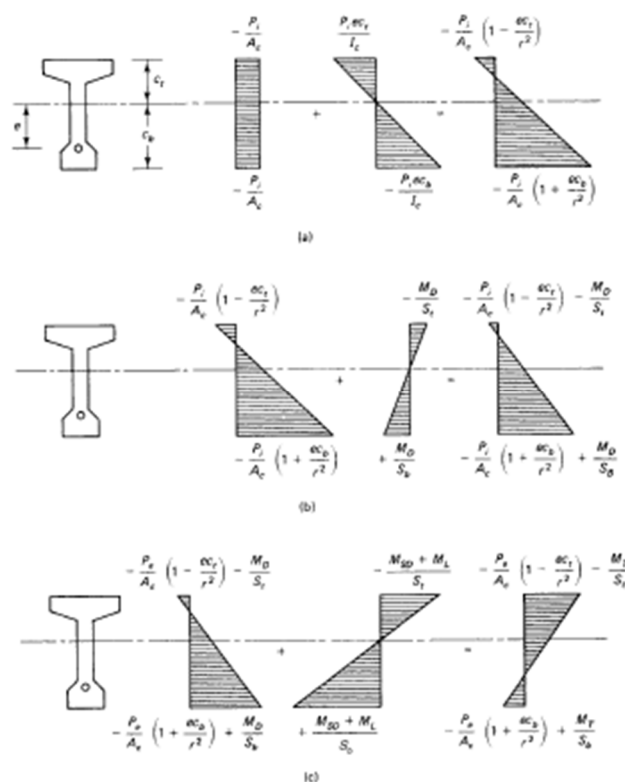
Esfuerzos de fibra elástica debido a las diversas cargas en una viga pretensada. (a) Pretensada inicial antes de las pérdidas. (b) Adición de peso propio. (c) Carga de servicio en pretensado efectivo. Fuente: Prestressed Concrete 5ta. Edición – Edward G. Nawy. Página 13.
